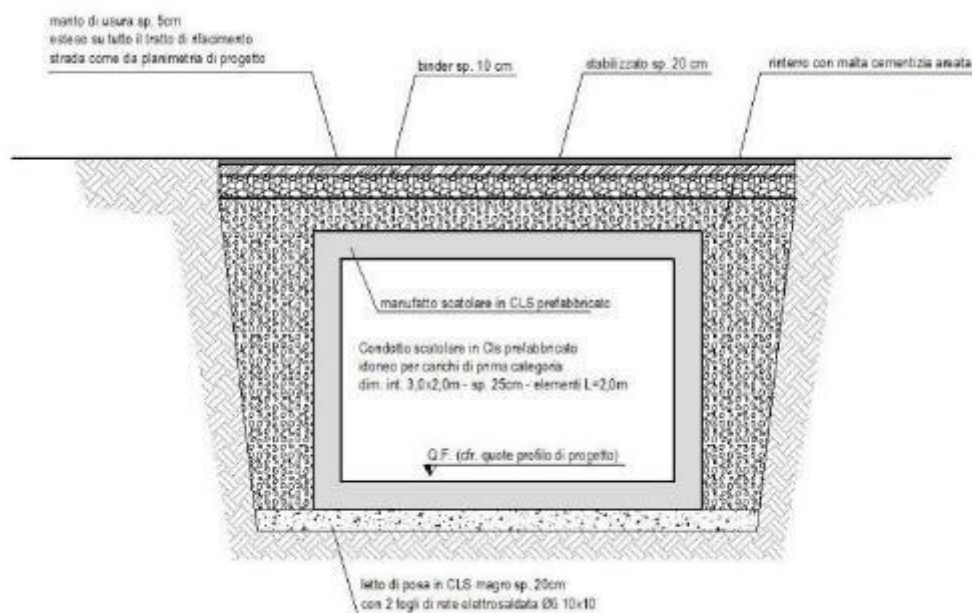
INTERVENTO DI PROGETTO, SEZIONE TIPOLOGICA 5 "CANALE IN CONDOTTO PREFABBRICATO IN CALCESTRUZZO ARMATO A SEZIONE RETTANGOLARE"
